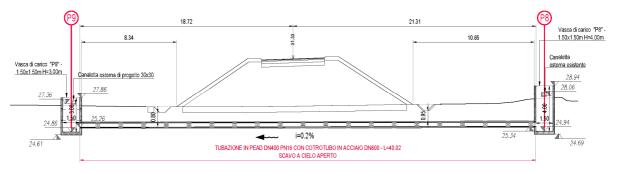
Attraversamento NV 06 alla pk 0+525,00 - Sezione Longitudinale
